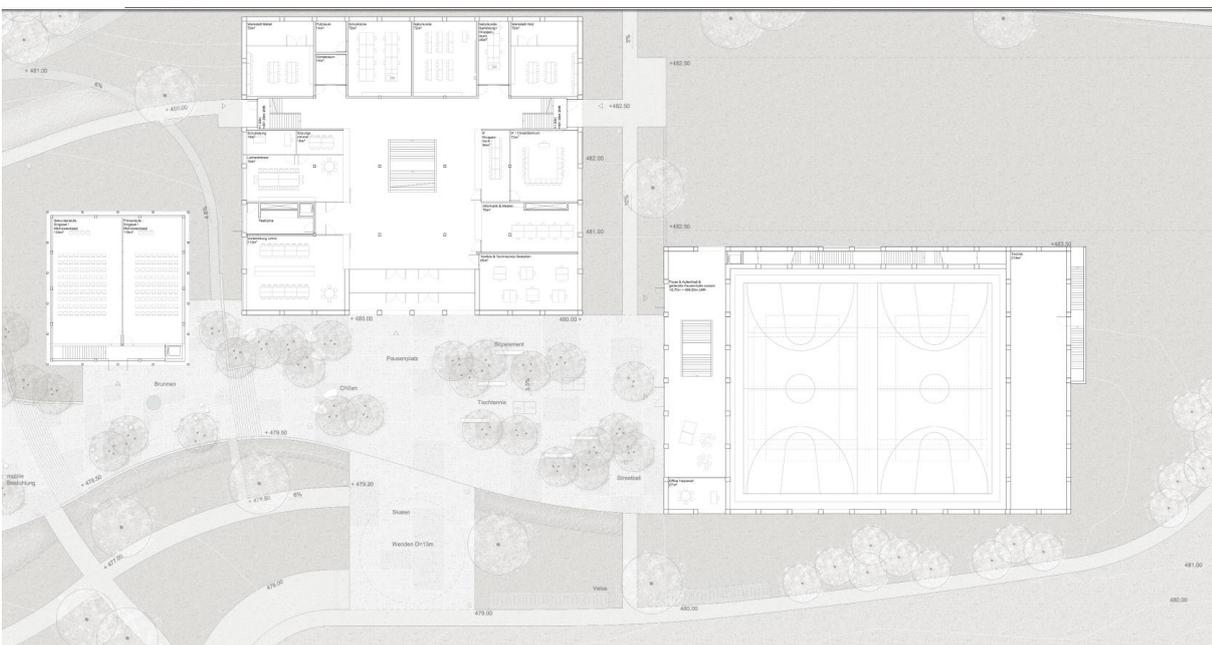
Grundriss Erdgeschoss Singsaal, Sekundarstufe und Doppelsporthalle
